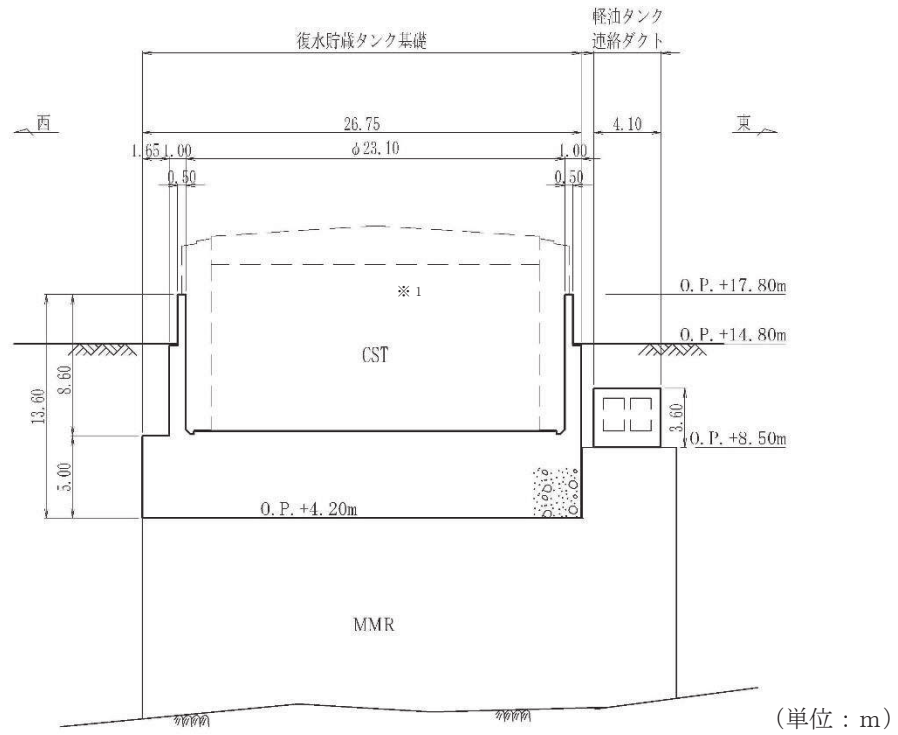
復水貯蔵タンク基礎断面図 (B-B 断面)
